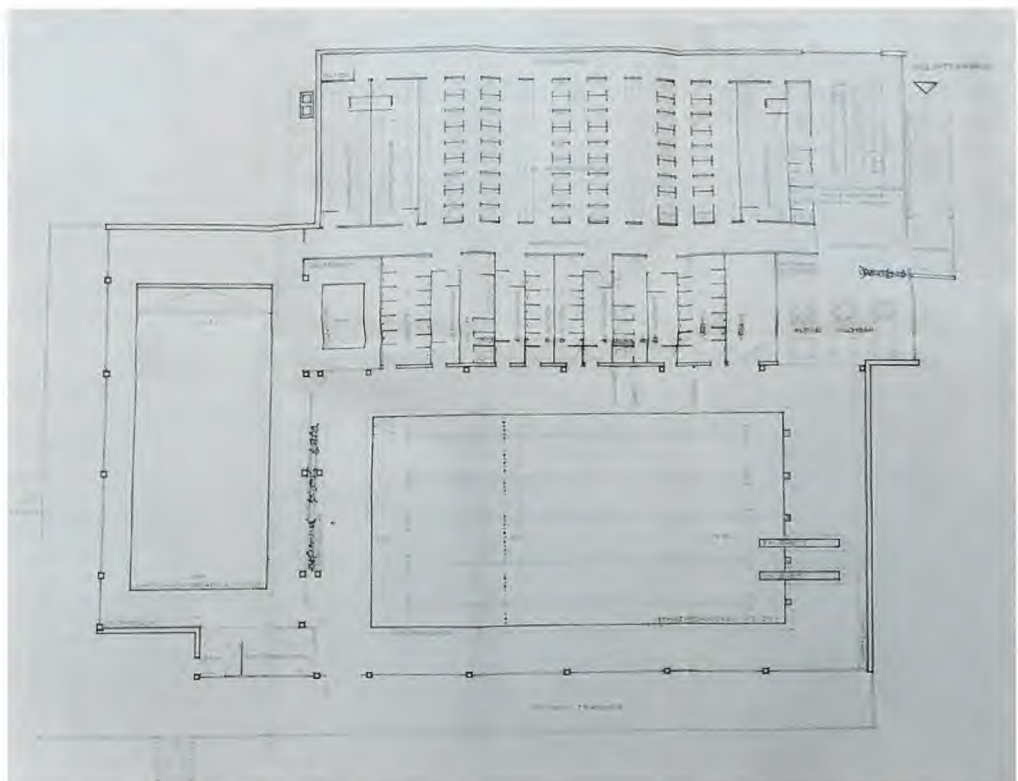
Raumaufteilung Planung Hallenbad Neubau 1970. Plan in Stadtarchiv, Akten nach 1945, IG Hallenbad Dachau e. V., Signatur 000 644. Repro: Autor
